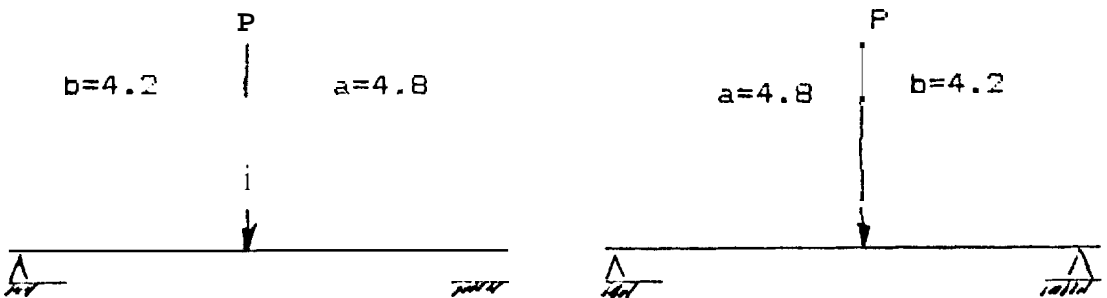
CARGA SOBRE CENTRO DE VIGA TRANSVERSAL
